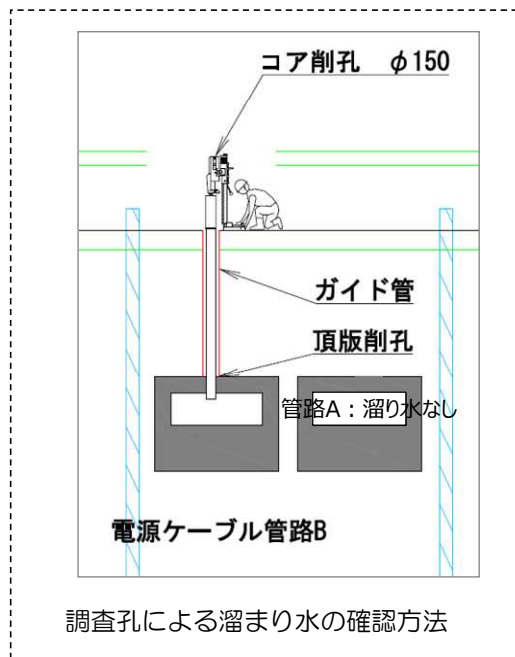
【12-4】2号機取水電源ケーブル管路A,B 施工方法（貫通施工）
